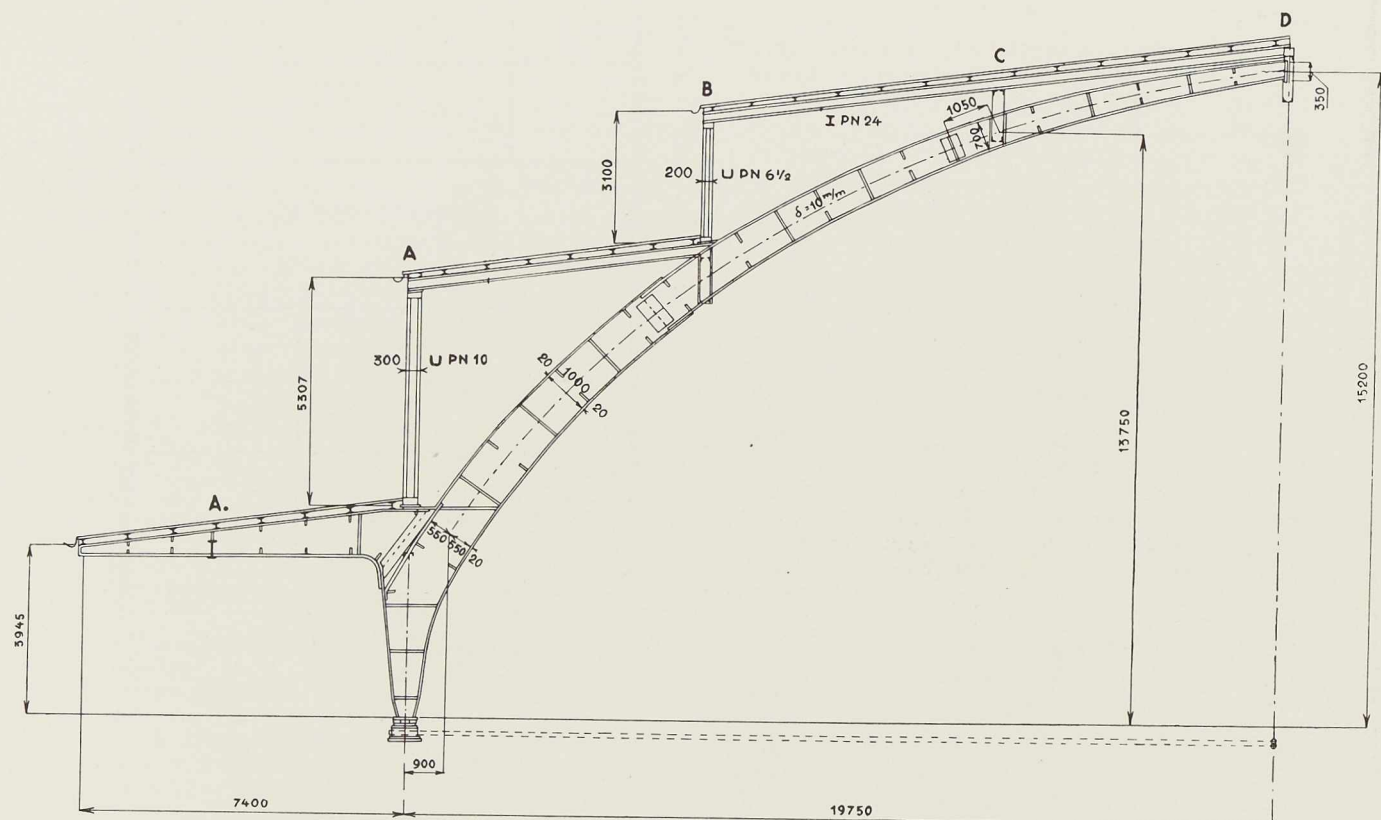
Marché couvert de Katowice (Pologne). Plan d'un demi-arc construit par soudure. Portée 39,50 m, hauteur à la clef 15,20 m.
